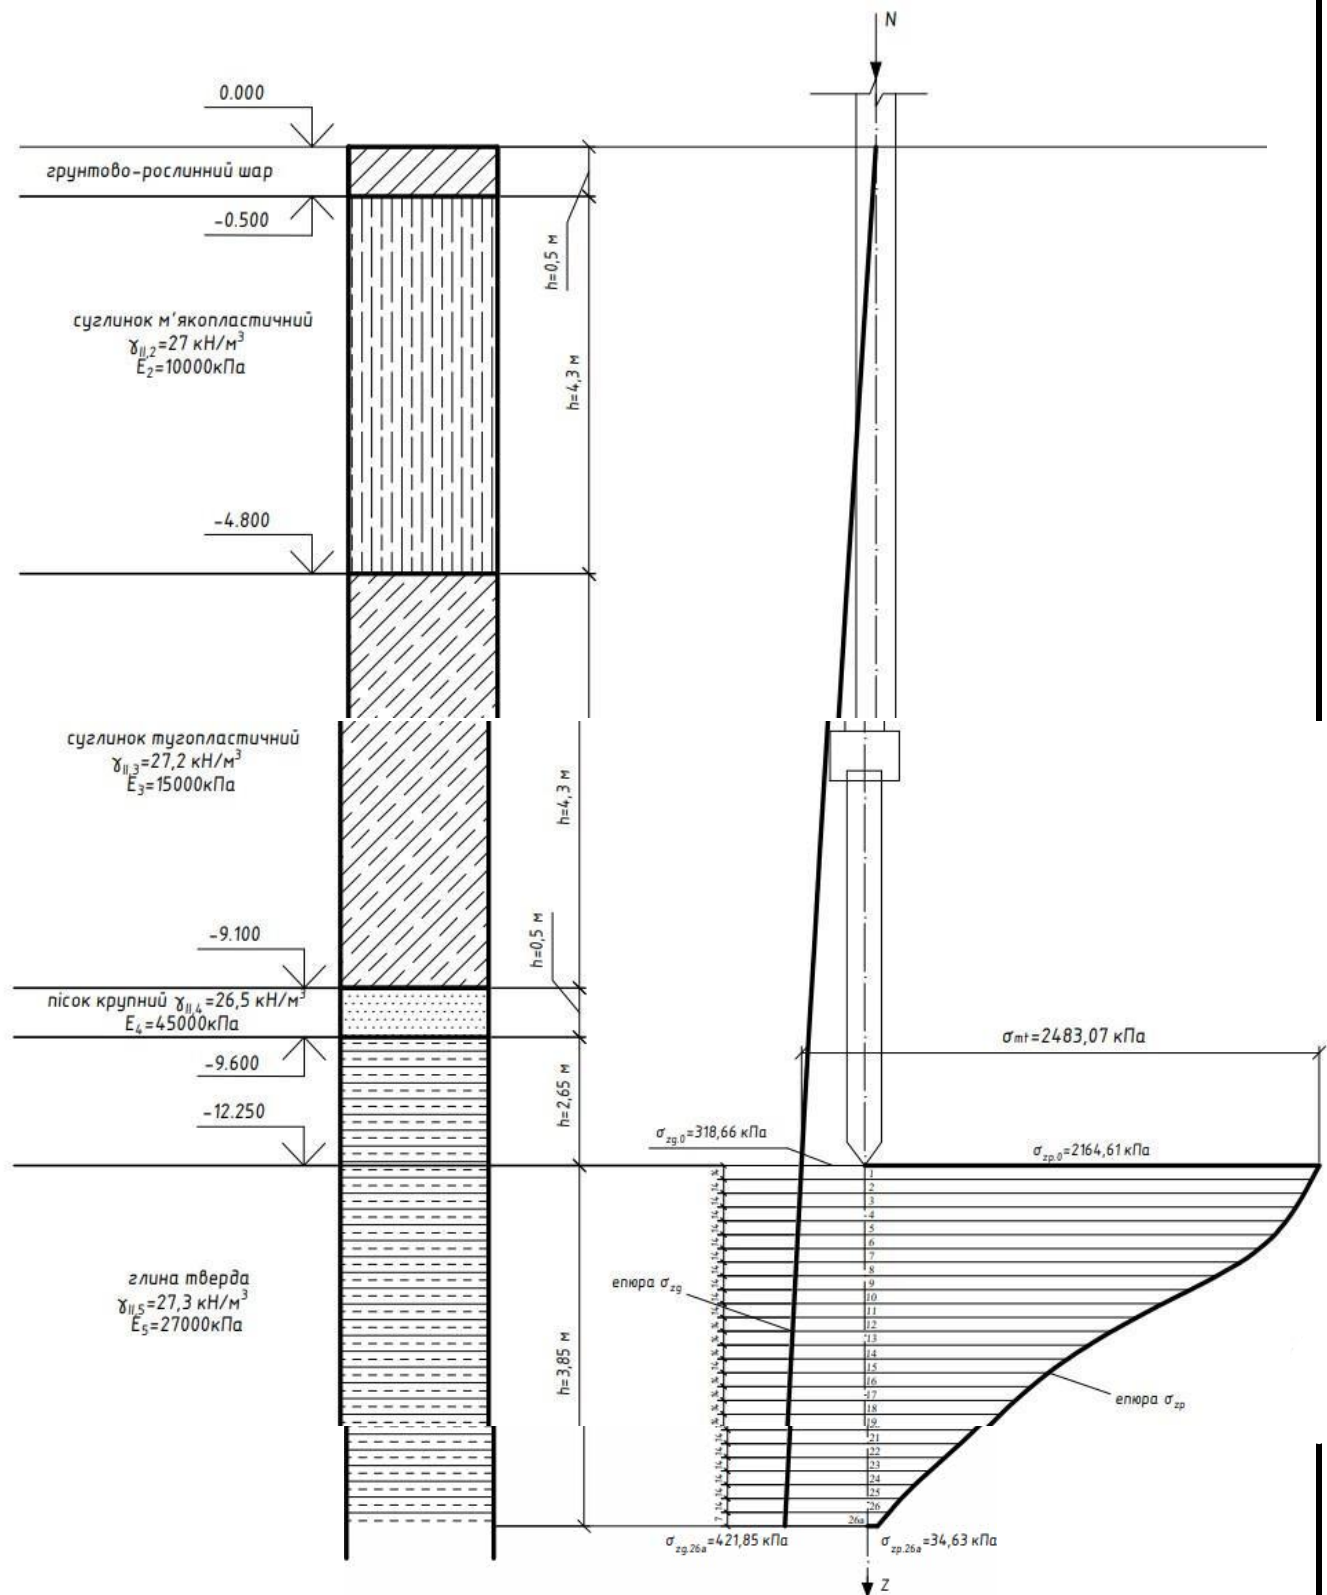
Схема до розрахунку осідання пальового фундаменту
